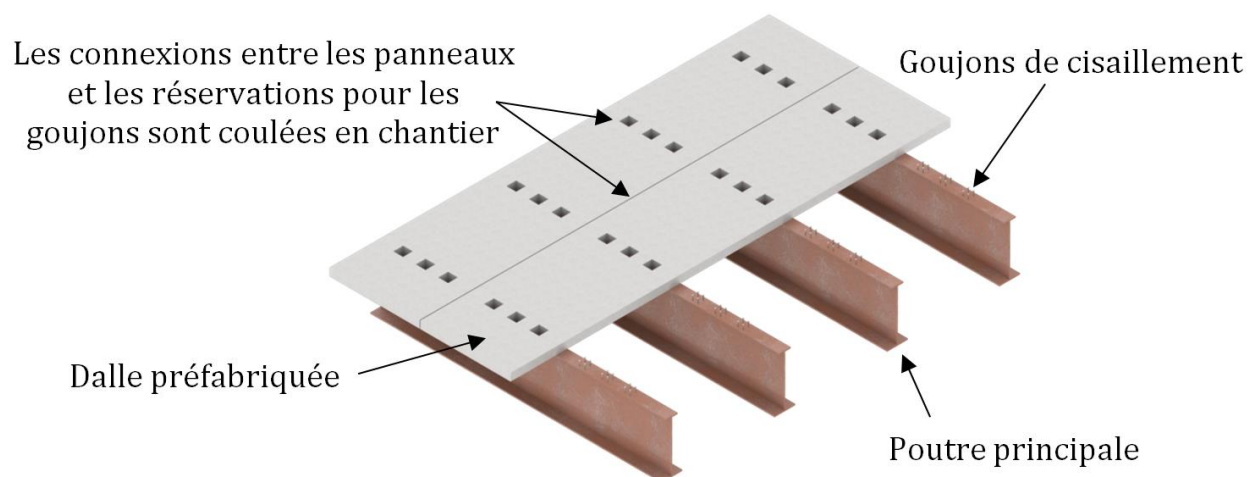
Vue conceptuelle du système de dalles préfabriquées
